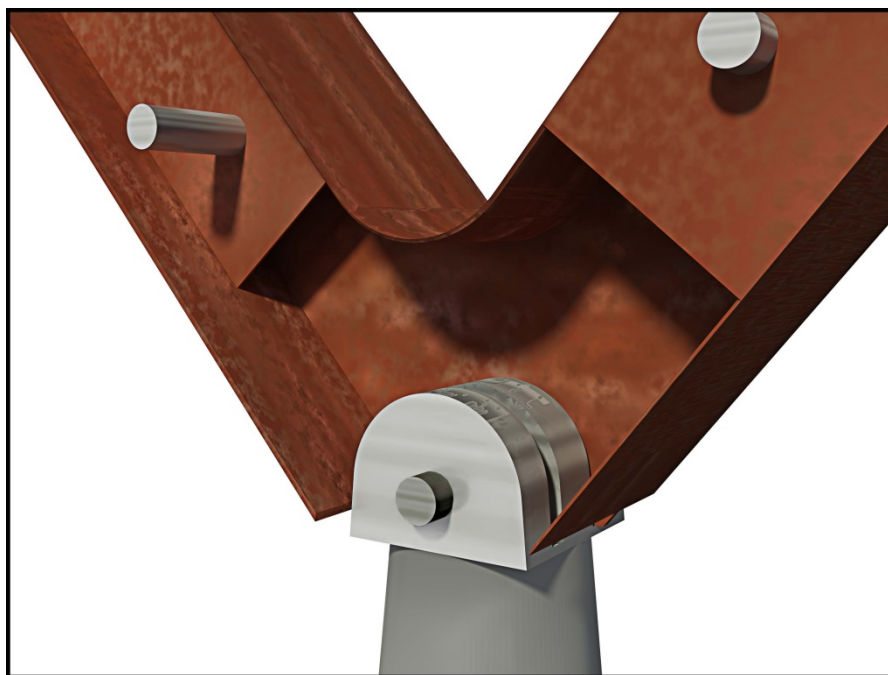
Appoggio sulla pila centrale e collegamento trave-impalcato.
